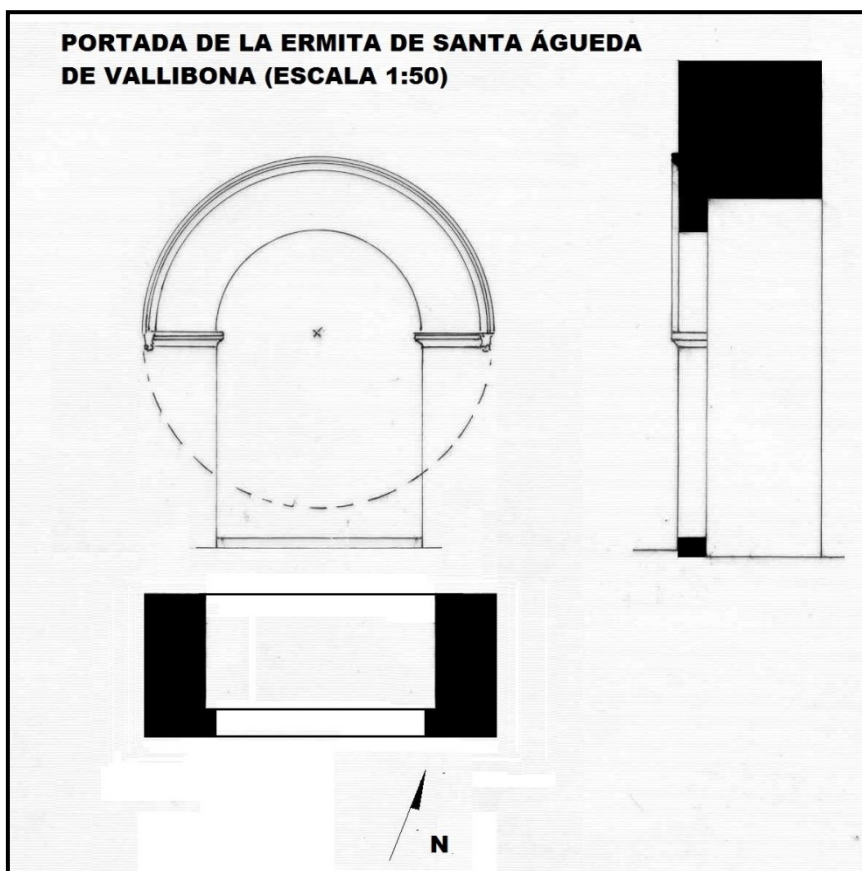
Diseño de la portada en alzado, planta y sección a escala 1:50 (F.J. Soriano)
